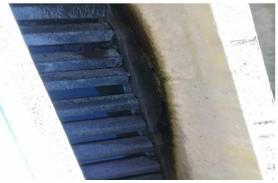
Pretratamiento de la Planta Depuradora: Desarenador.
